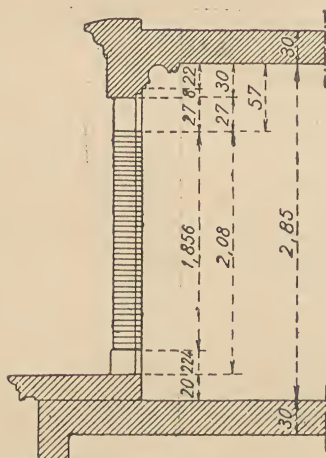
Coupe dans une baie du 4<sup>e</sup> étage de la façade (partie de gauche) sur l'impasse.
